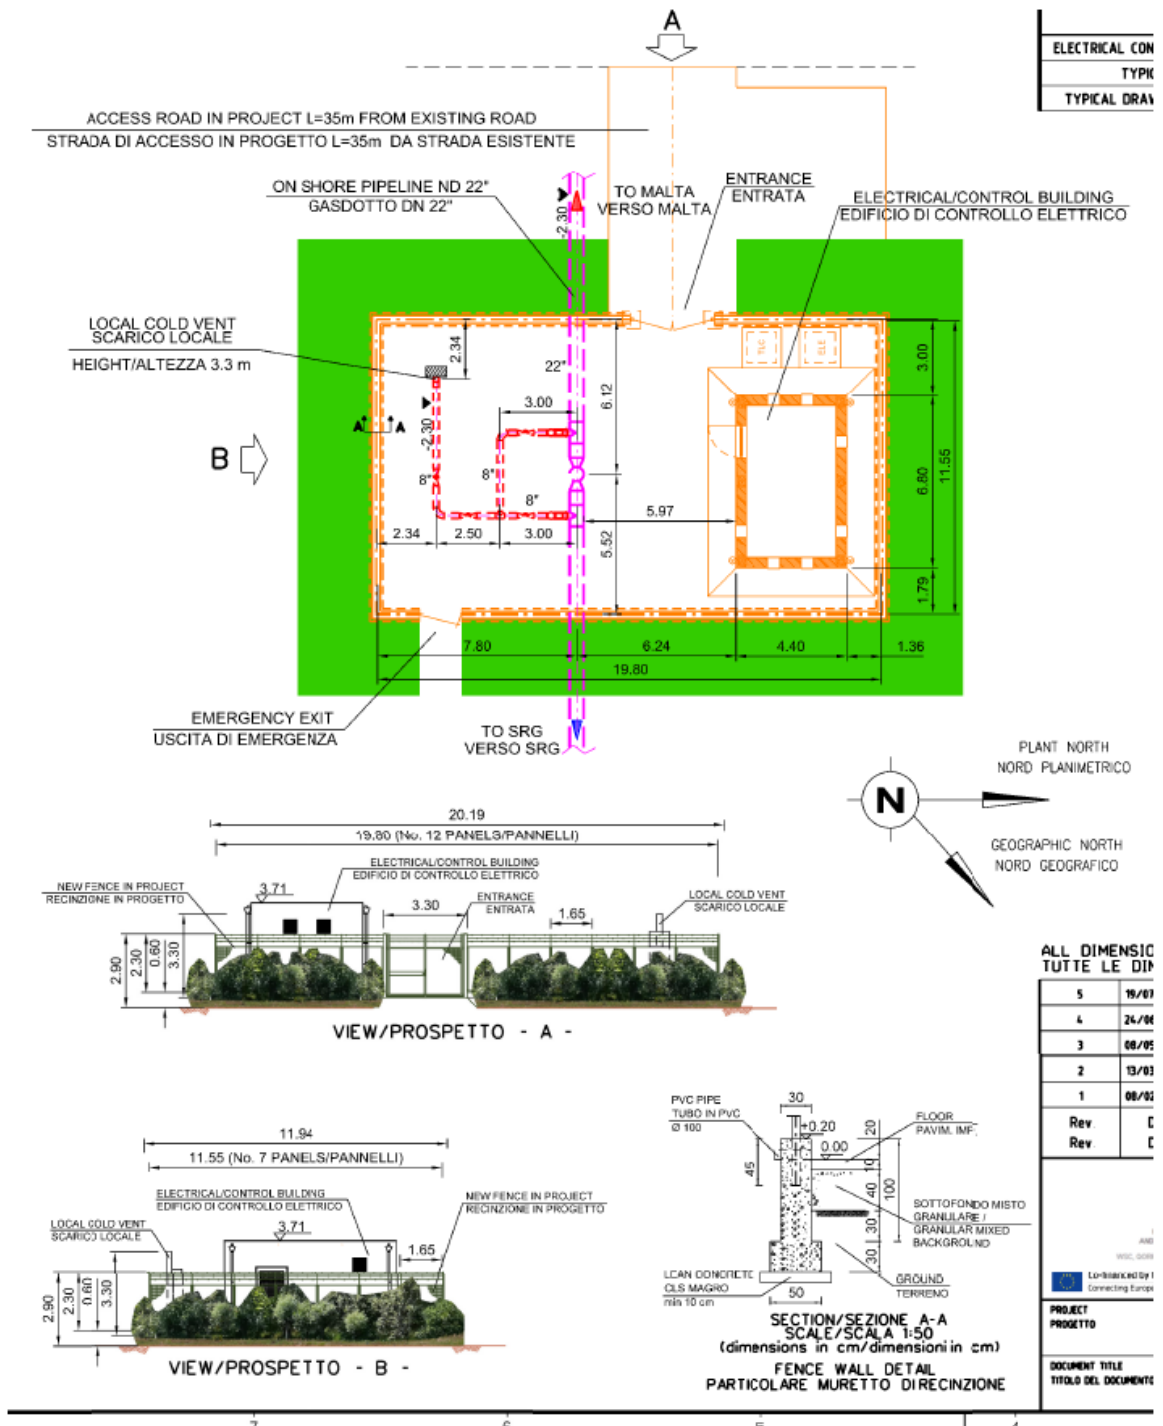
Punto di intercettazione di linea 3 – Planimetria e prospetti
